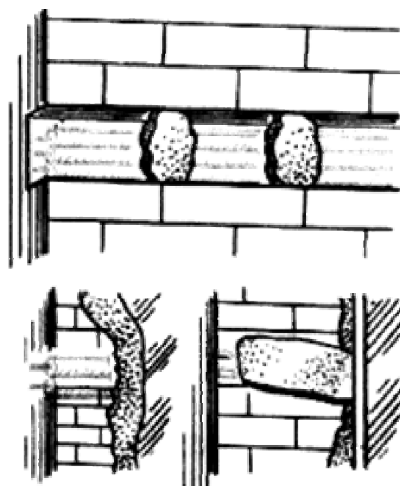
Скрытые электропроводки под несгораемыми основаниями
